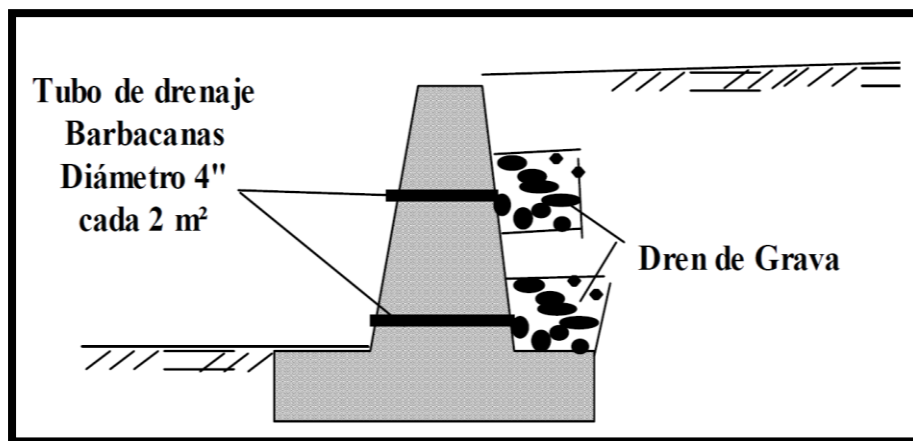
Drenaje de los Muros de Contención con Barbacanas
